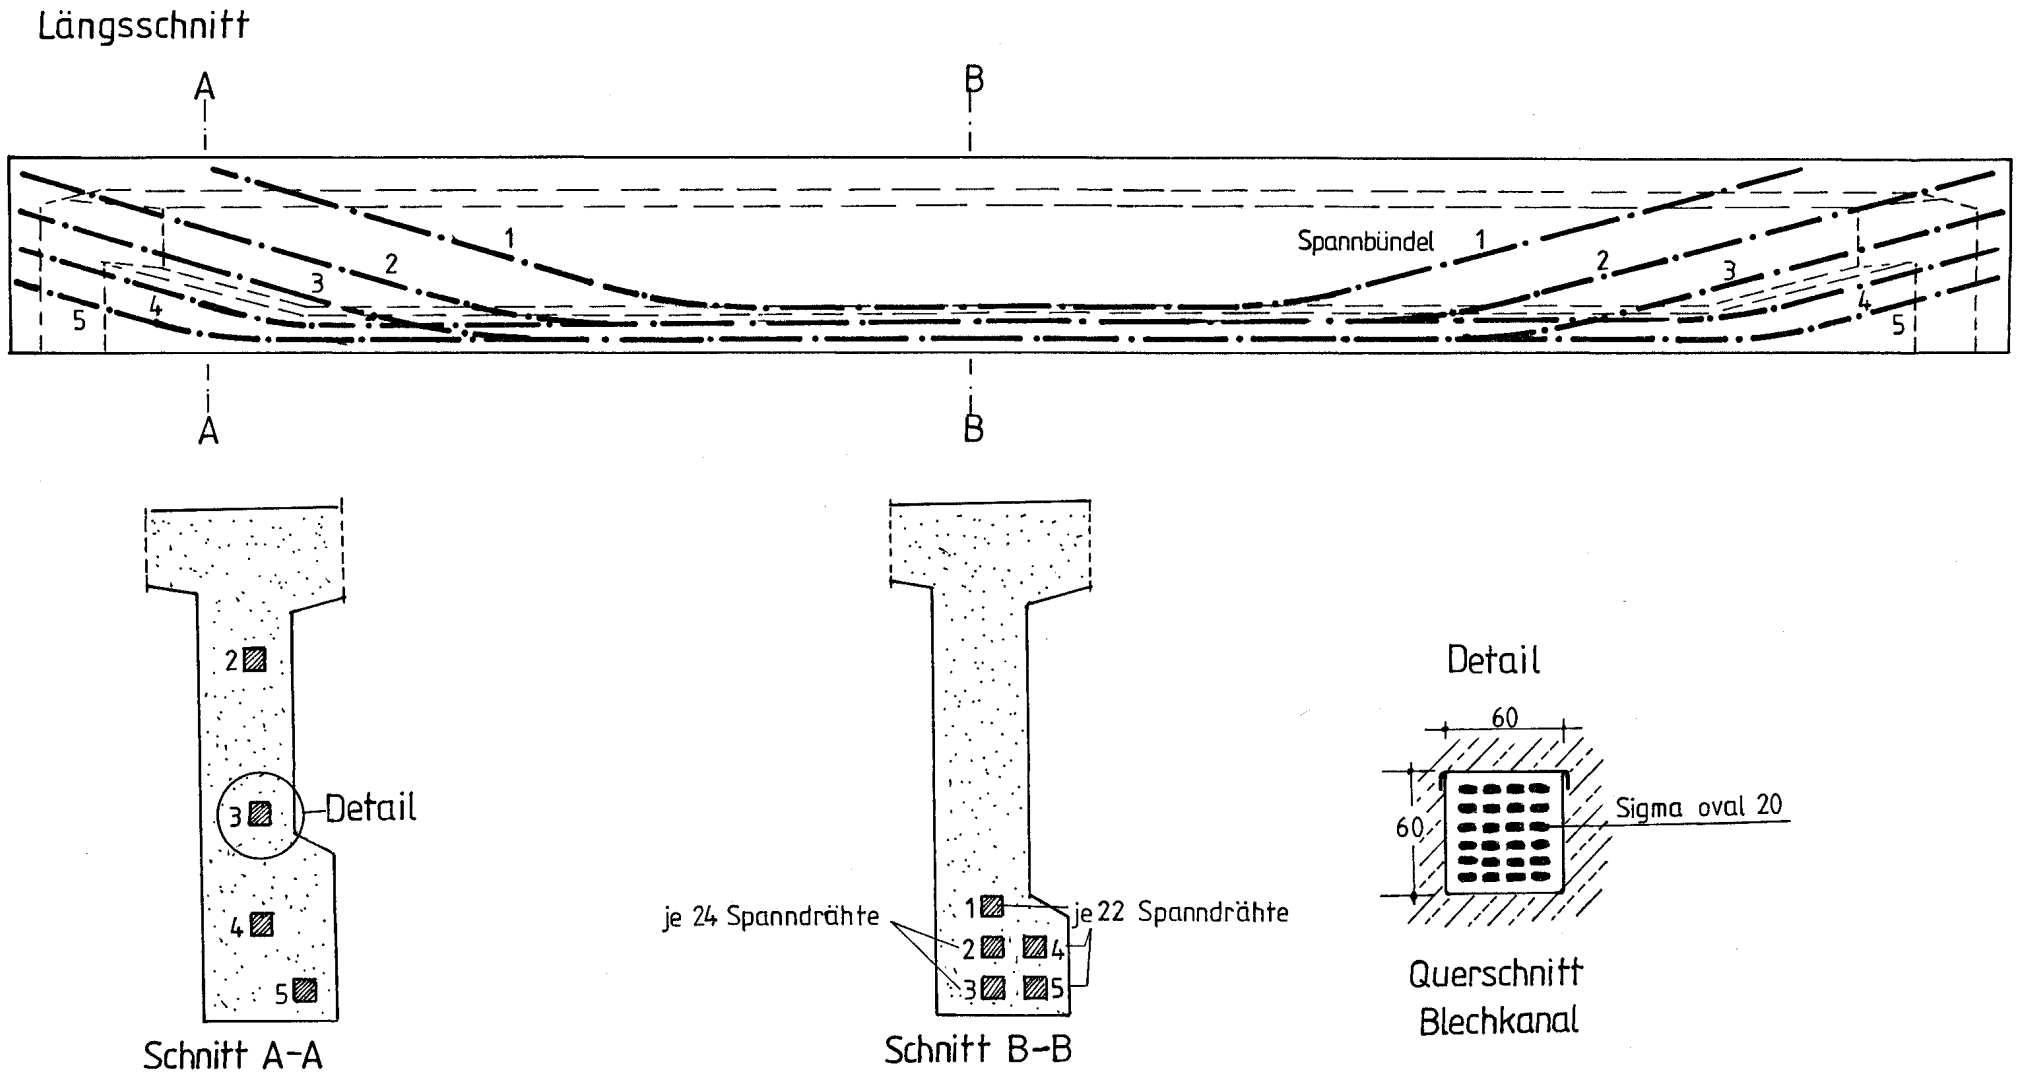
Spannbewehrung eines Brückenträgers im Längs- und Querschnitt
